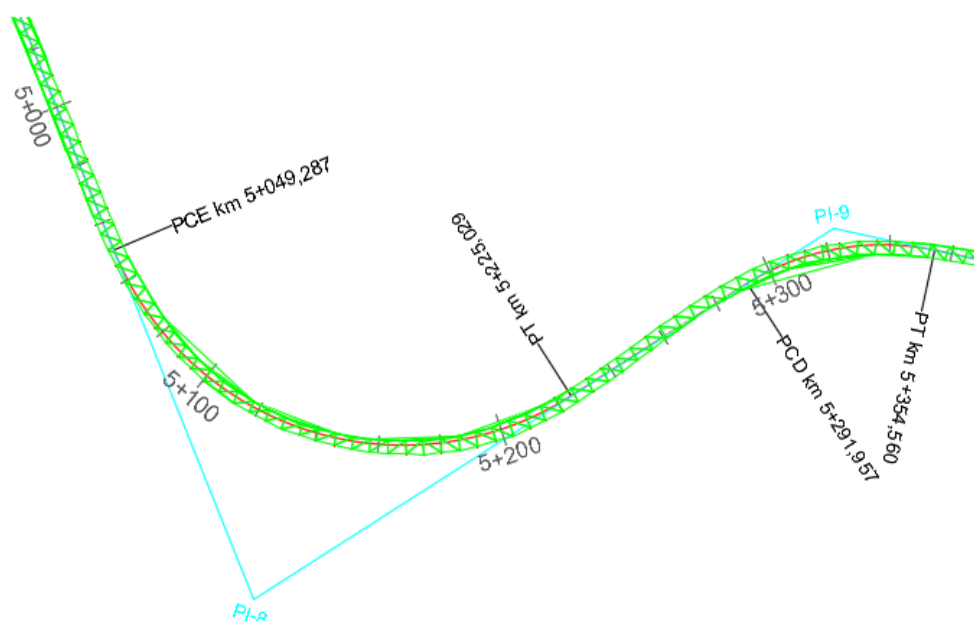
Detalhe da obtenção dos elementos da planimetria
